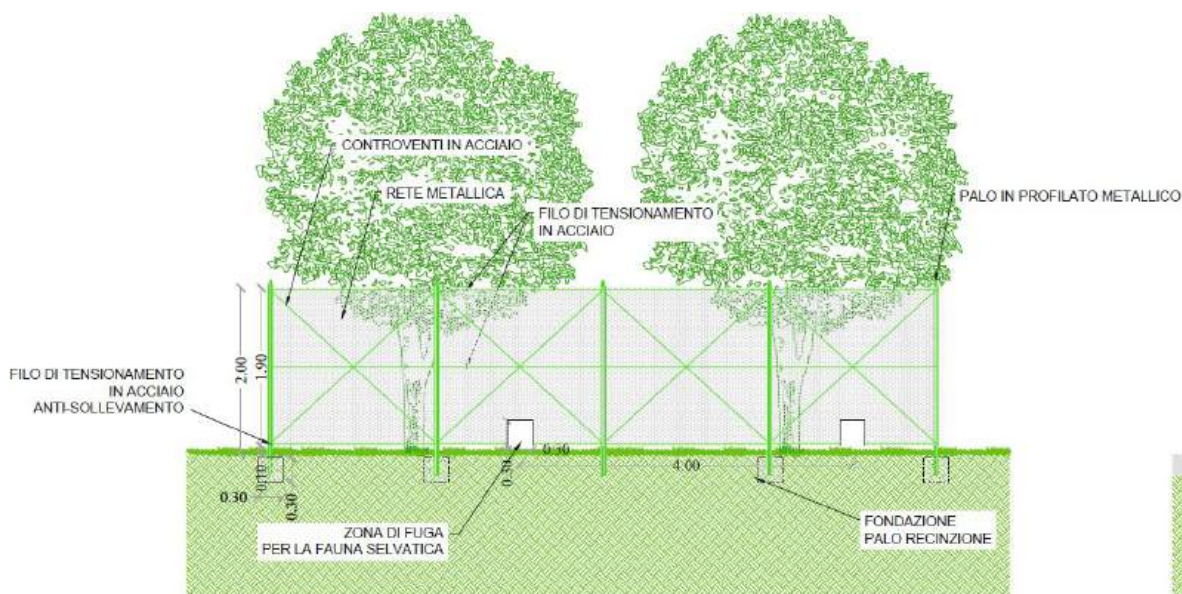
Particolare della recinzione prevista per le arre di impianto
